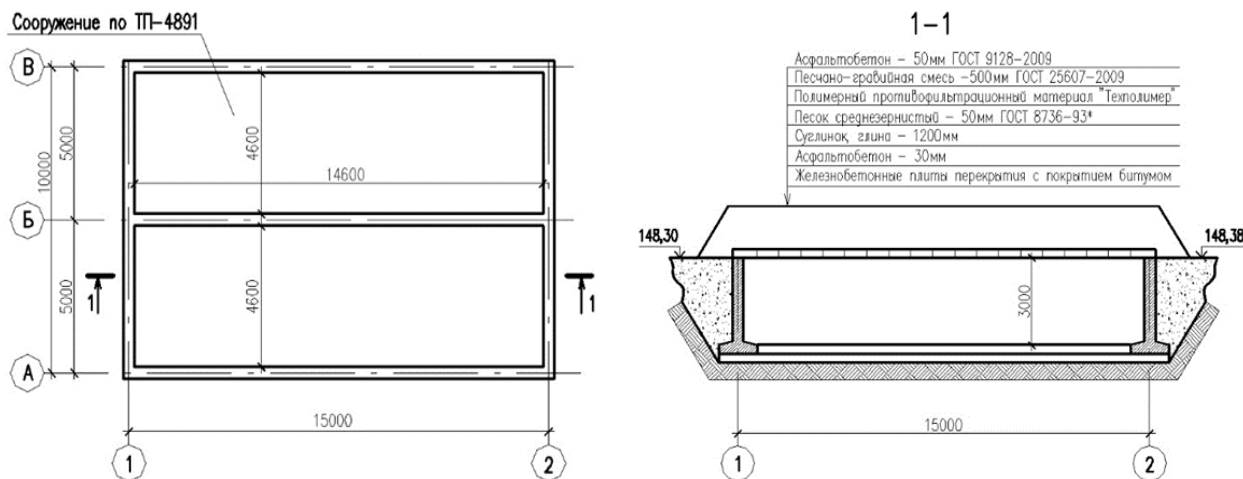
Схематичный план и разрез хранилища после проведения ремонта
